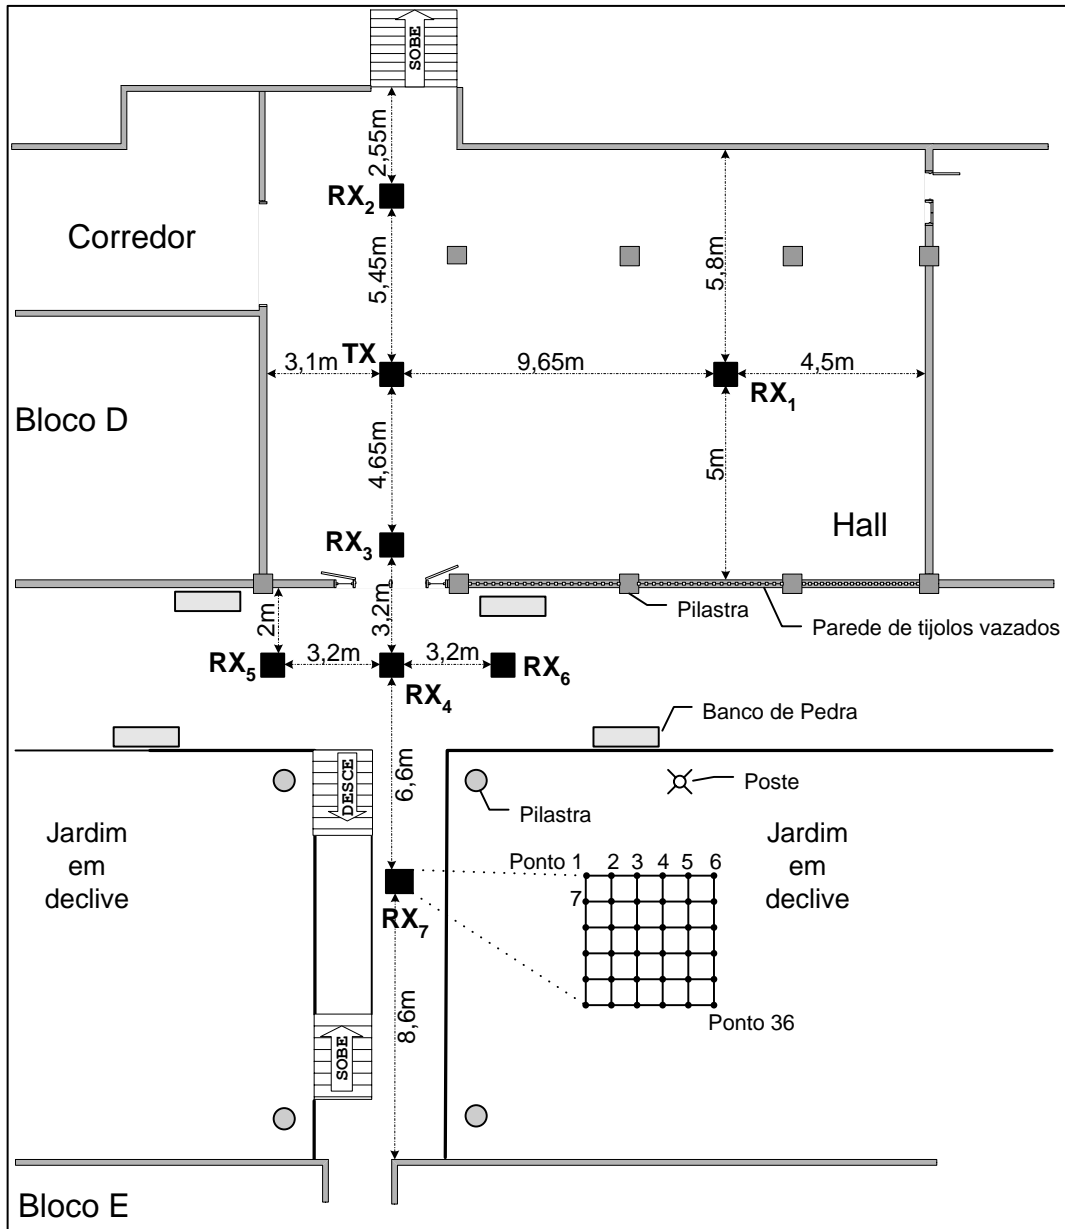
Planta baixa do ambiente de medição (hall) [20].
